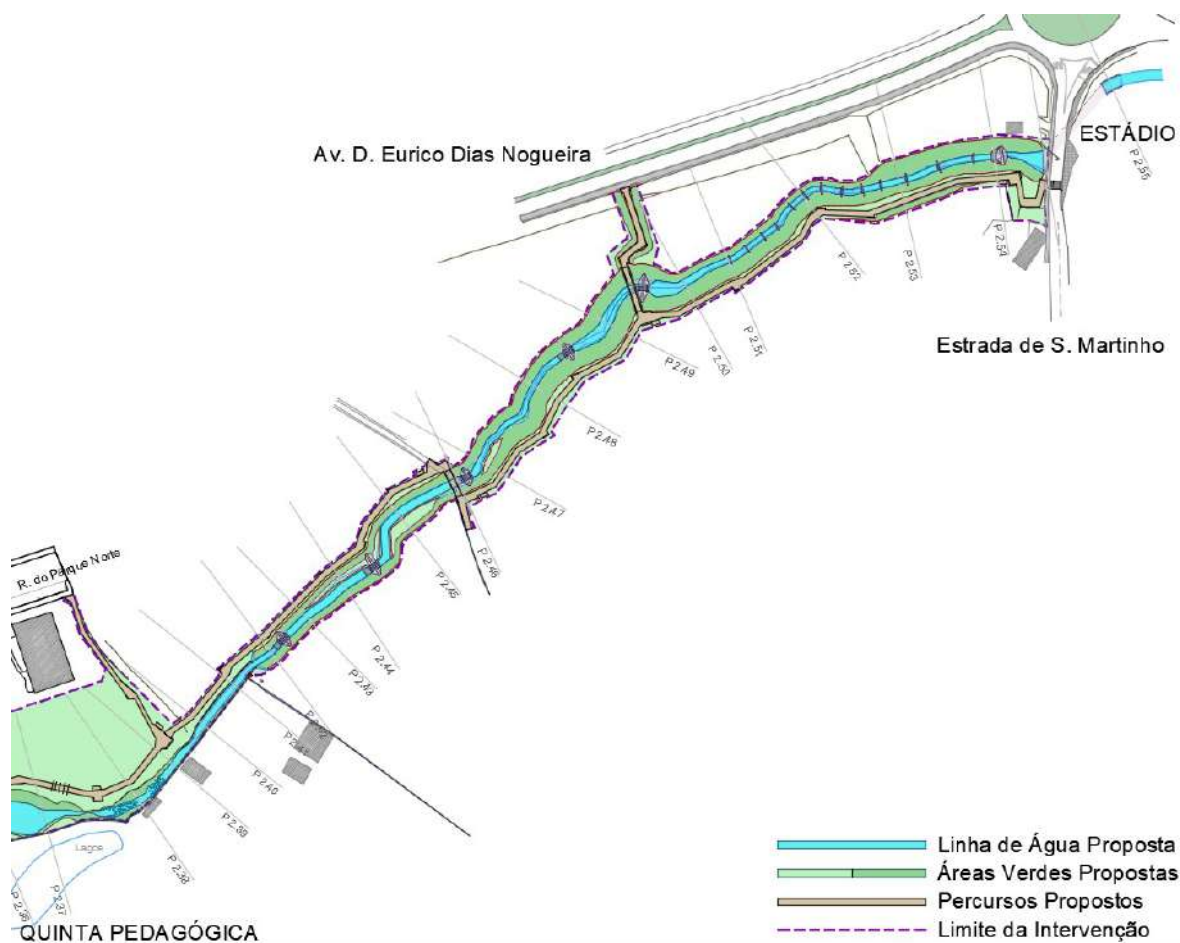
Plano Geral – Zona jusante do troço 2 entre a Quinta pedagógica e o Estádio de Futebol
